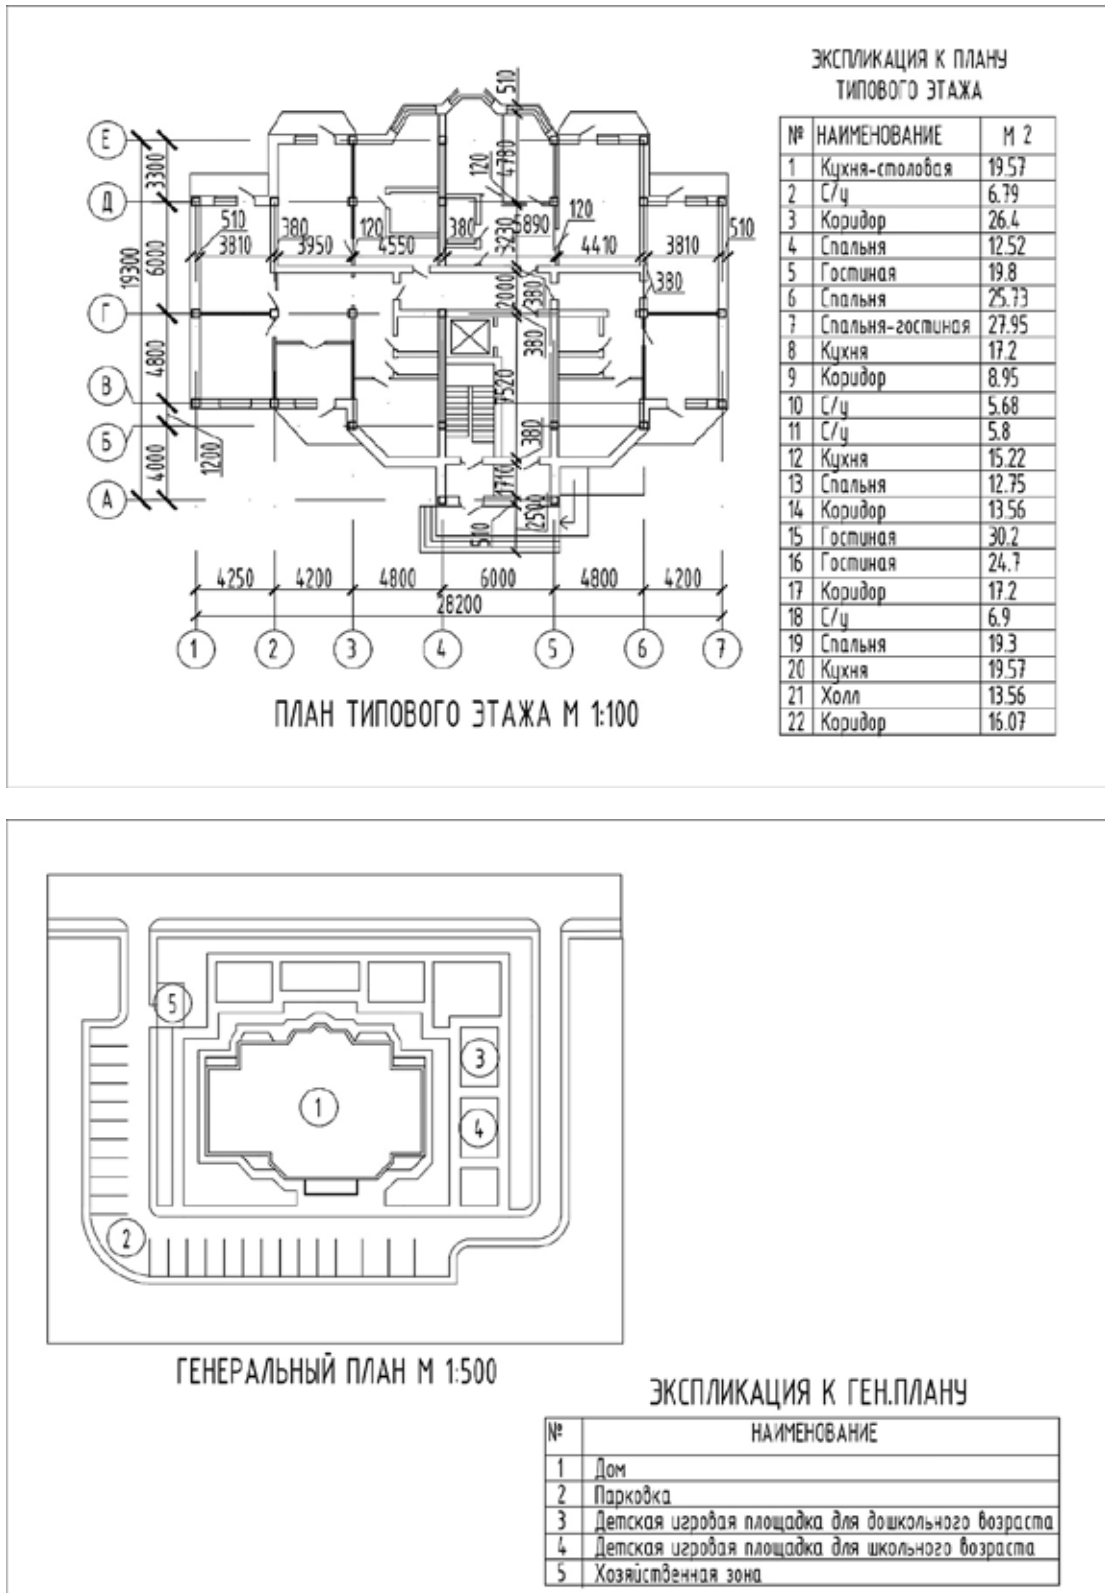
План типового этажа и генеральный план малоэтажного жилого дома
